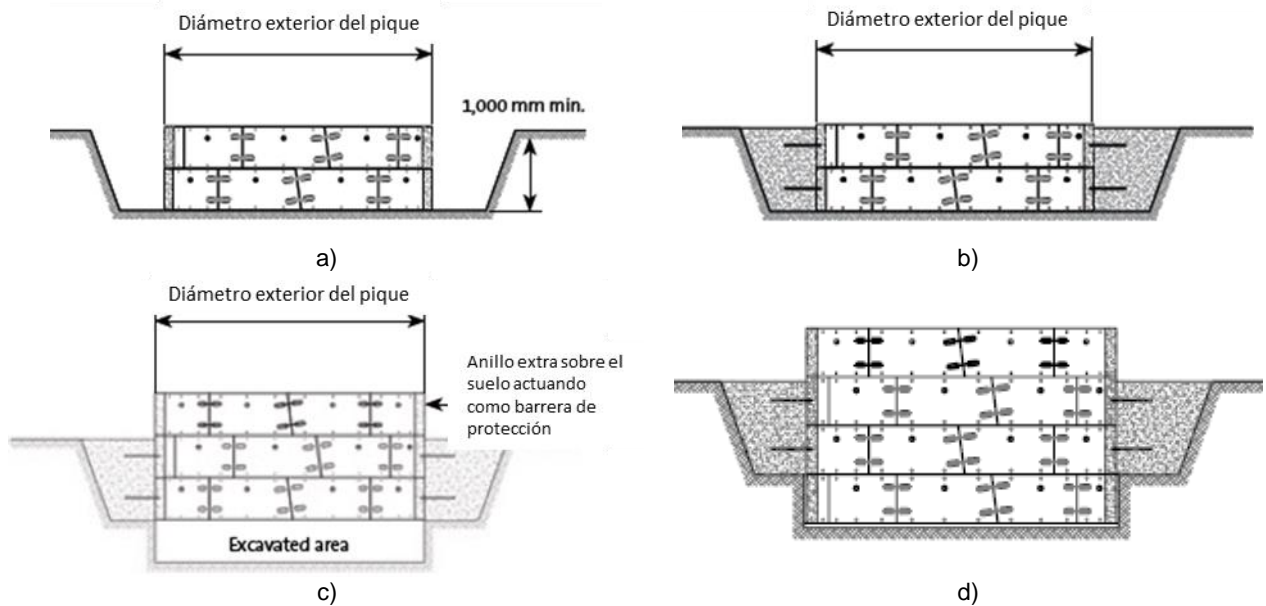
Secuencia de instalación. a) Excavación inicial, primeros anillos construidos. b) Construcción collar de hormigón. c) Excavación sección siguiente. d) Instalación de dovelas de hormigón prefabricado en área excavada. Humes (2012).
